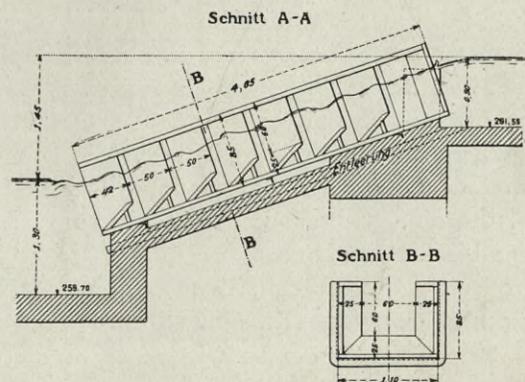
Elektrizitätswerk Augst. Grundriss und Schnitt einer Rinne der Deniltreppe. Maßstab 1 : 75.
